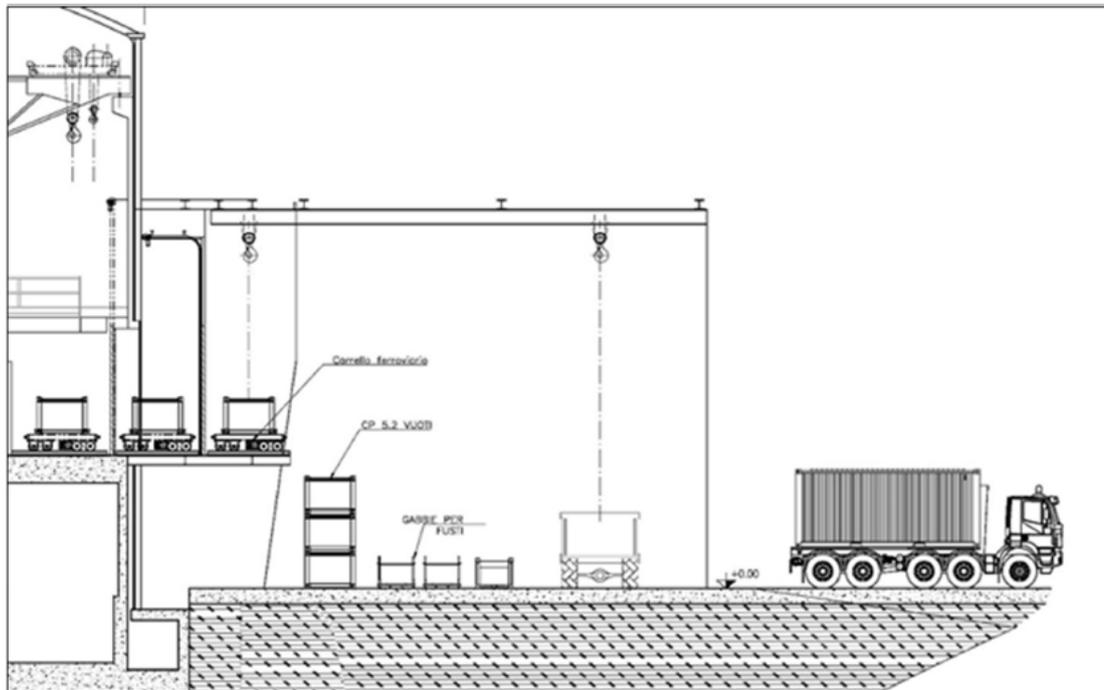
Layout sistemazione accesso lato Sud al Contenitore Stagno
